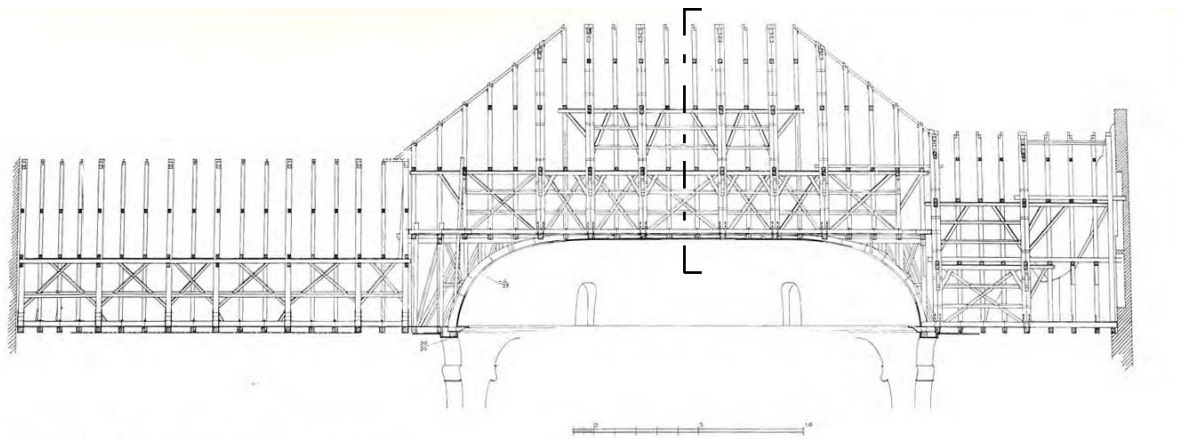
Längsschnitt Hauptdachwerk der Wallfahrtskirche in der Wies mit Markierung der Querschnittführung
